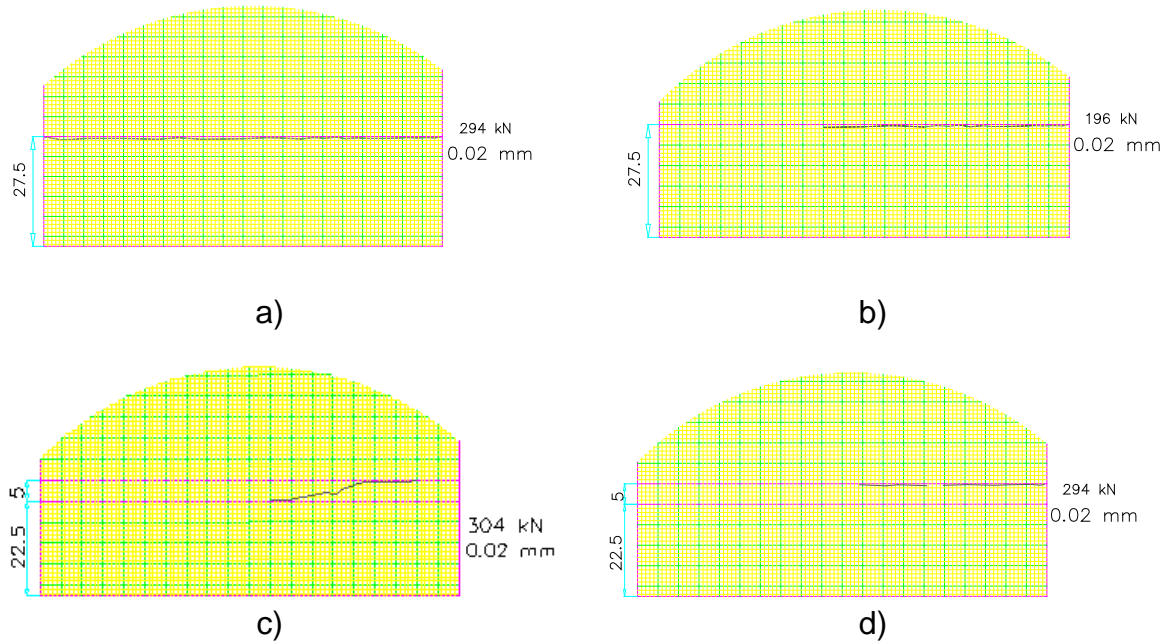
Agrietamiento en parte del cambio de sección (vista superior en planta) bajo carga simétrica última de diseño: a) espécimen E1, b) espécimen E2, c) espécimen E3 y d) espécimen E4
